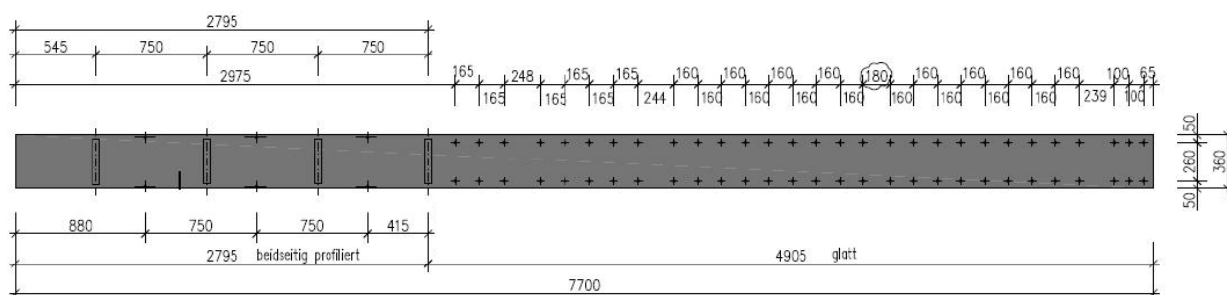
Abwicklung des SBK mit Klemm- und einbetoniertem Bereich
